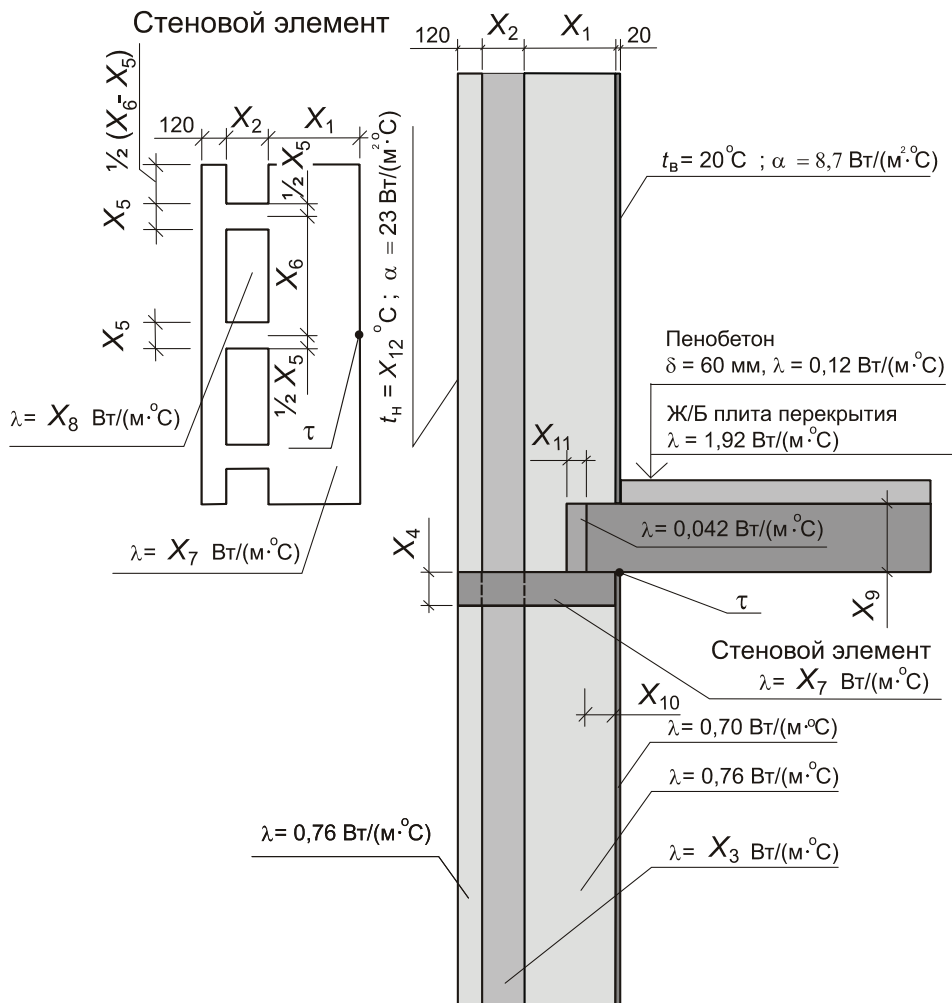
Схема узла наружной трехслойной стены в месте опирания плиты перекрытия на стеновой элемент
